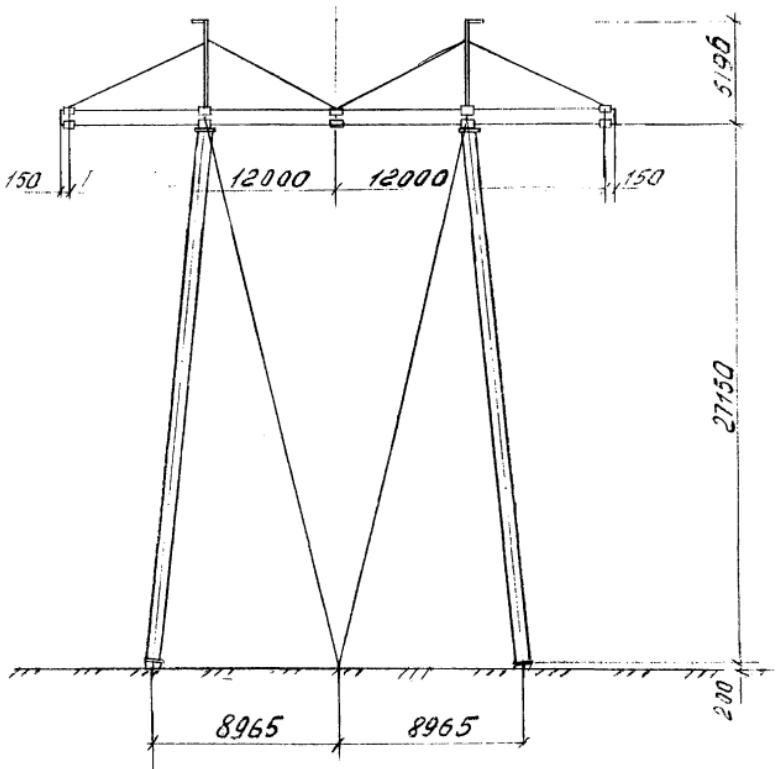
Промежуточные железобетонные опоры типа ПБ 500-3.
